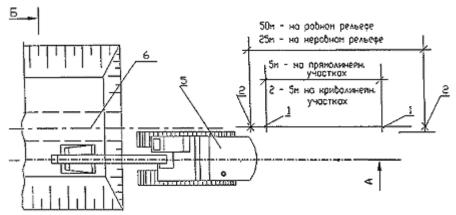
Схема геодезической разбивки траншеи в плане
